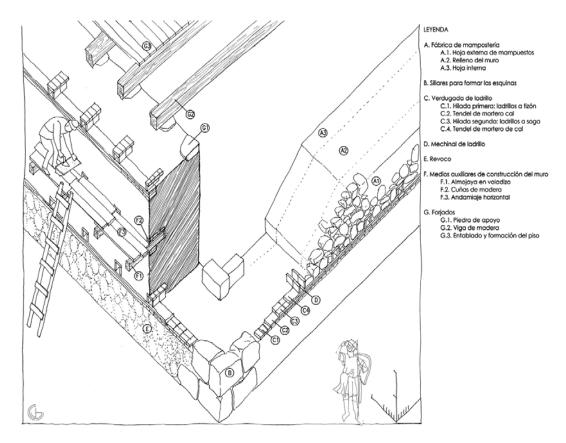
Análisis gráfico de la construcción de los muros de mampostería con verdugadas de ladrillo del castillo de Arcos de Jalón
